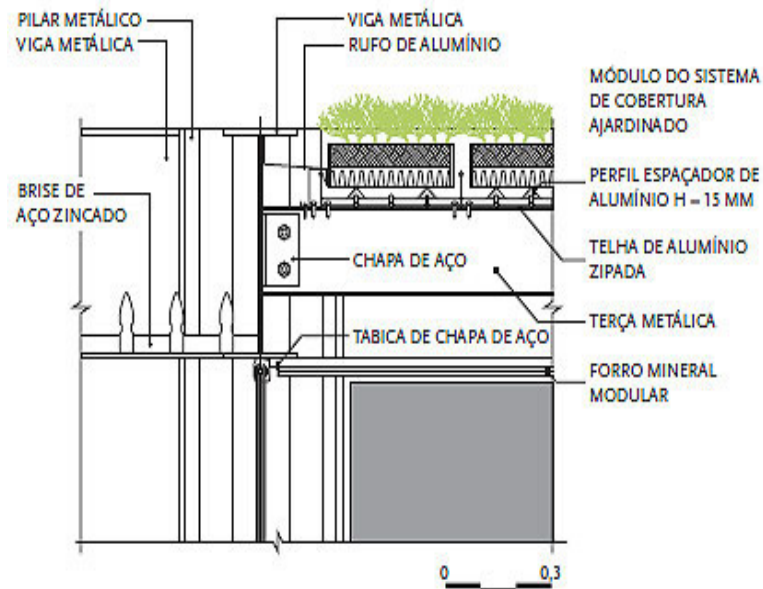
Detalhes construtivos da cobertura do TJDFE.
